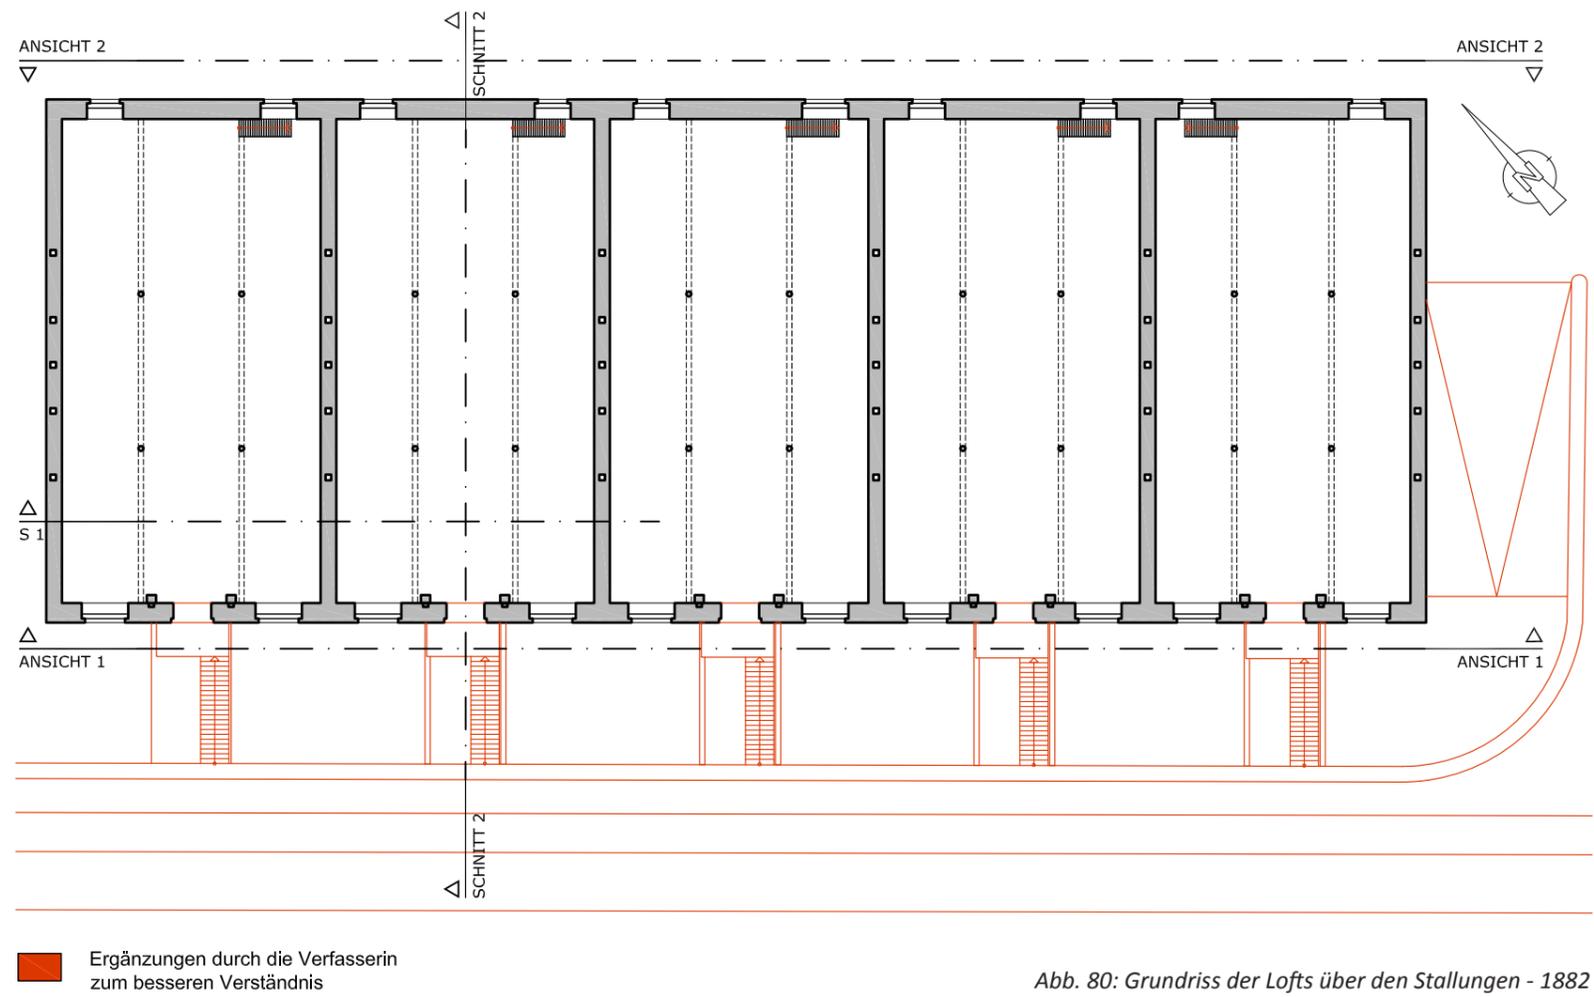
Grundriss der Lofts über den Stallungen - 1882
